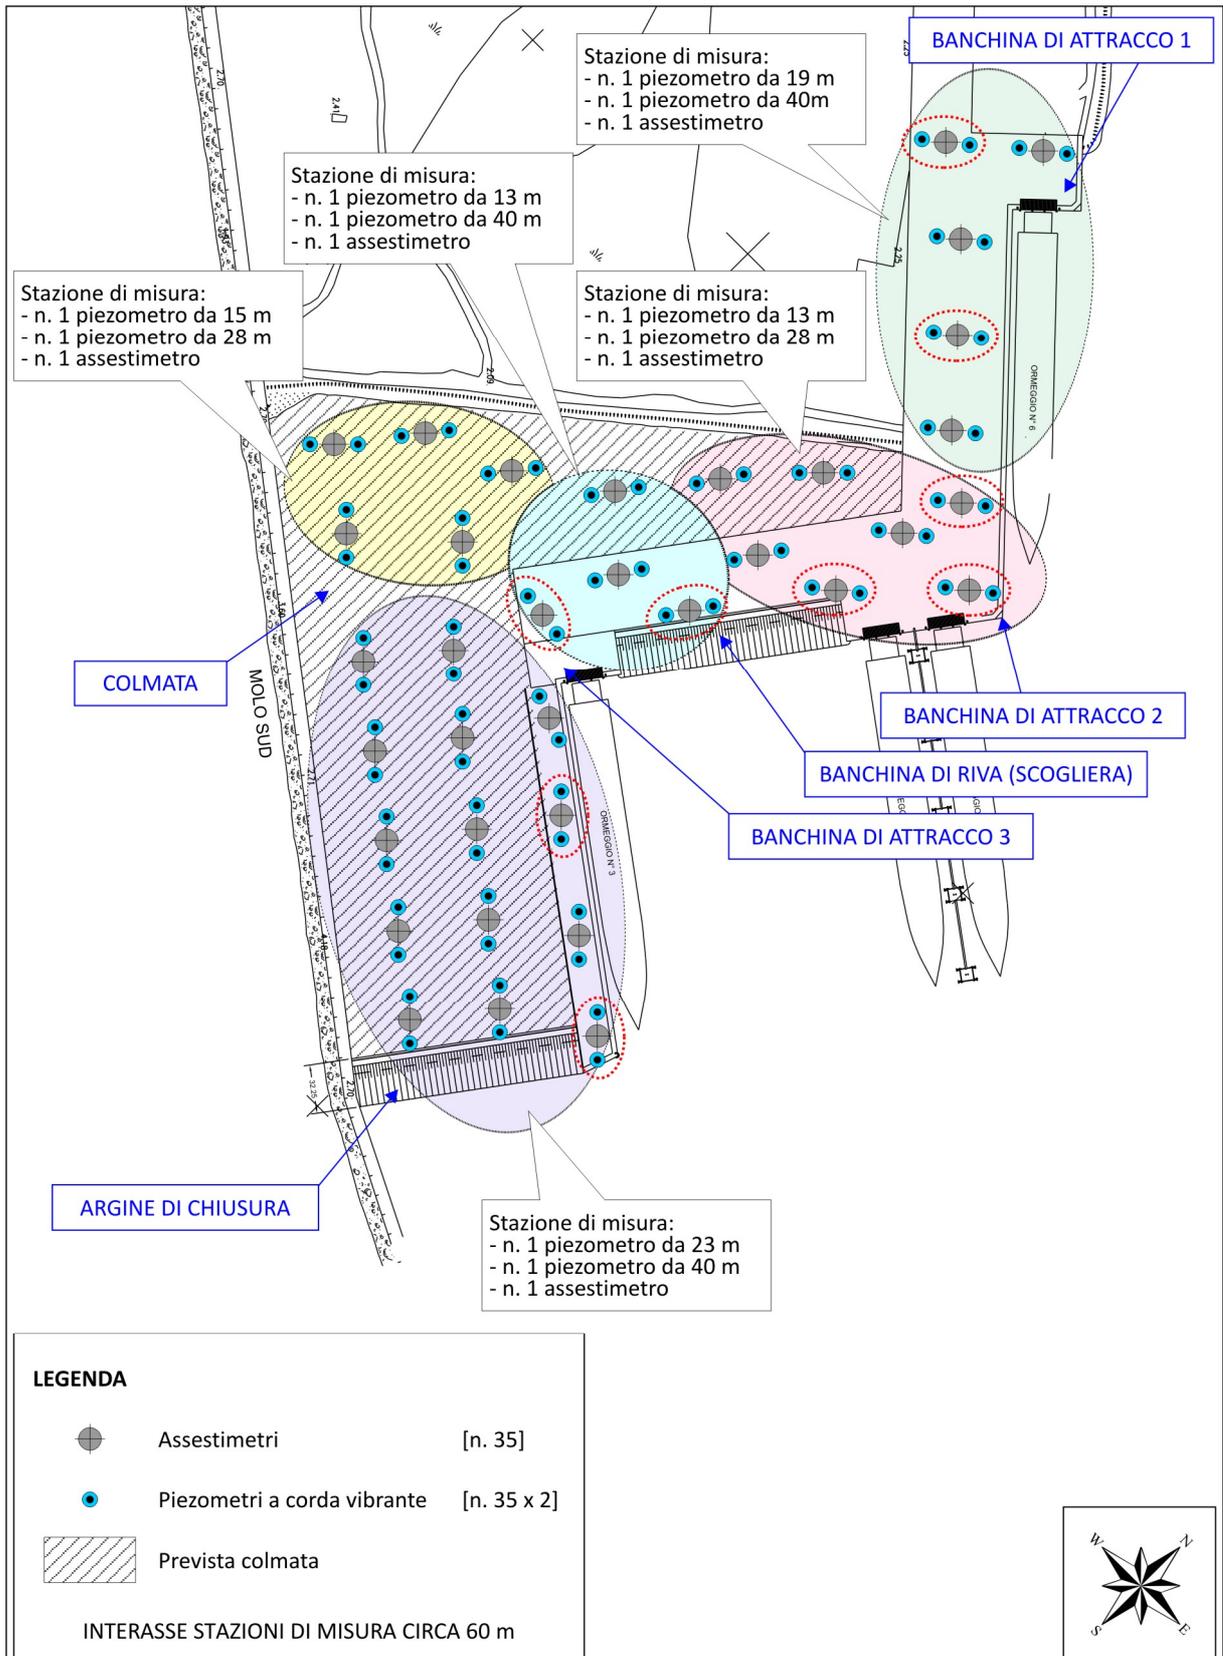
Distribuzione planimetrica degli assestimetri e dei piezometri a corda vibrante
